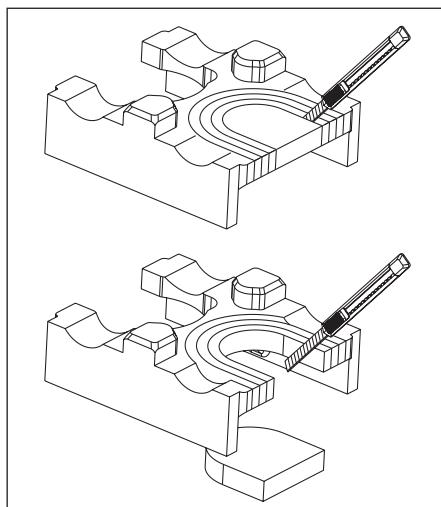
Einlegeblock mit Ausschnitt für Wärmemengenzähler
